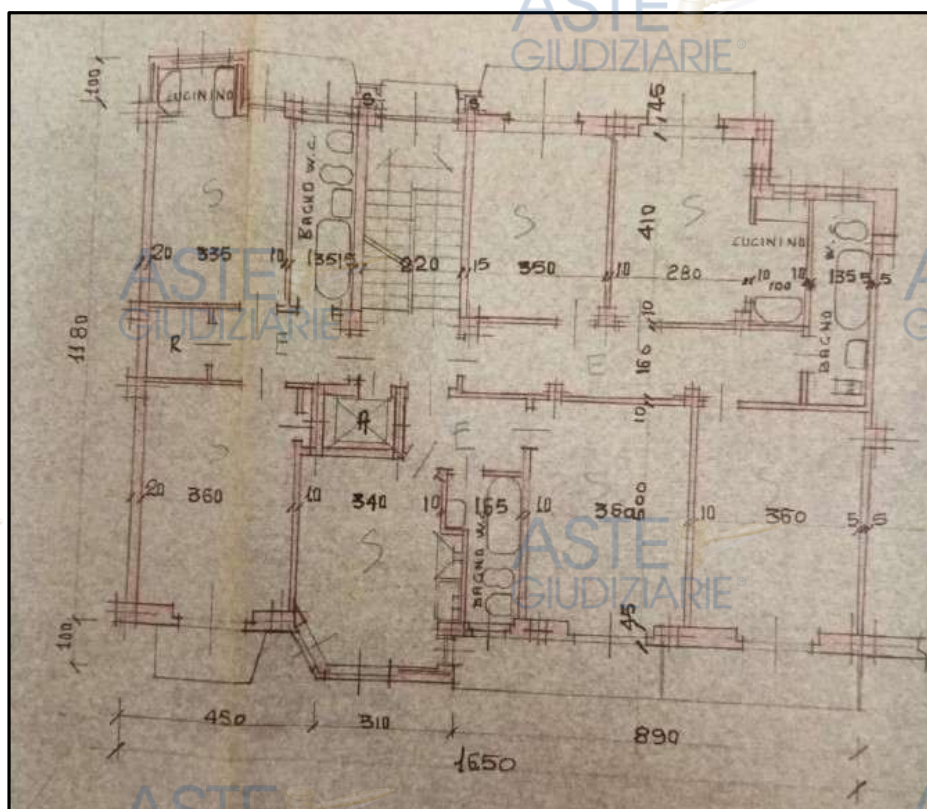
Estratto planimetria piano progetto Licenza edilizia prot. n. prot. 1957/121011
